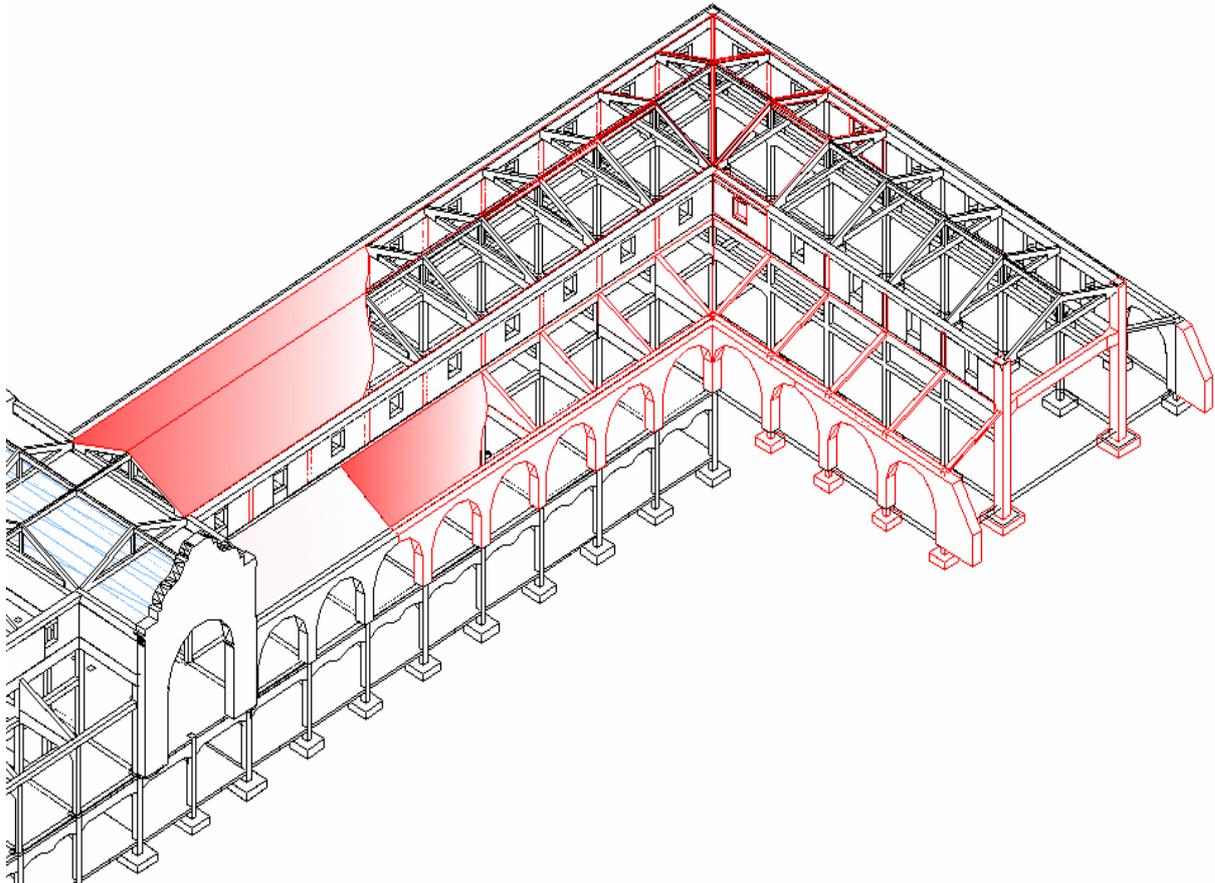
Intervenciones de reconstrucción, rehabilitación y refuerzo sobre la estructura remanente del Ex Mercado de Abasto
